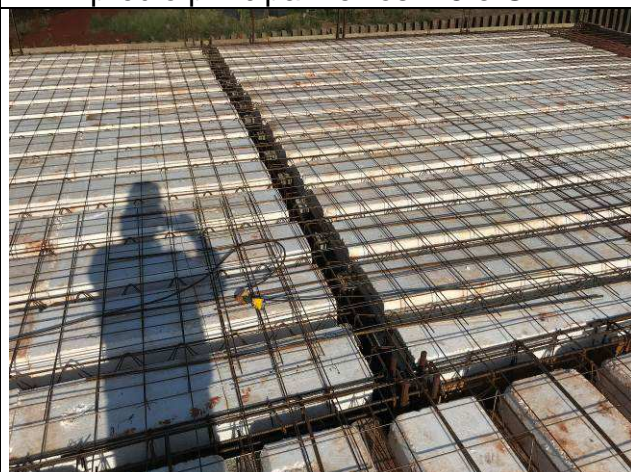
C: Laje e vigas de cobertura do prédio principal - eixos 1-5 e G-I.
